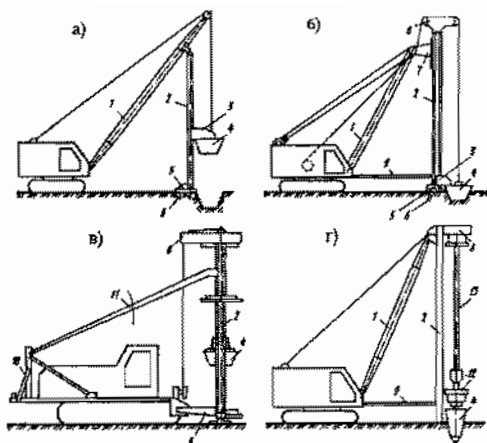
Оборудование для вытрамбовывания котлованов: а - на экскаваторе со стрелой драглайна; б - на экскаваторе с прямой лопатой; в - на базе трактора; г - на базе свесбойного агрегата; 1 - стрела; 2 - направляющая стойка (штанга); 3 - каретка; 4 - трамбовка; 5 - упорная плита; 6 - зубья; 7 - серьга; 8 - оголовок; 9 - распорка; 10 - противовес; 11 - подвеска; 12 - молот; 13 - штанга
